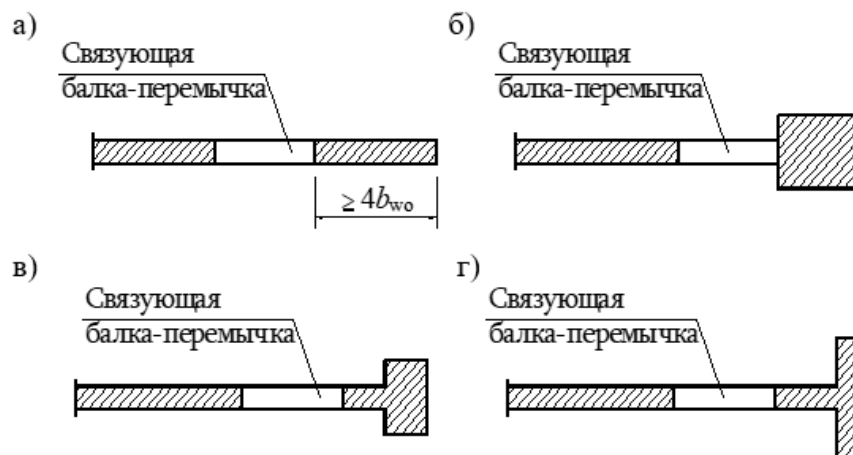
К определению расстояний от торцов стен до краев проемов
